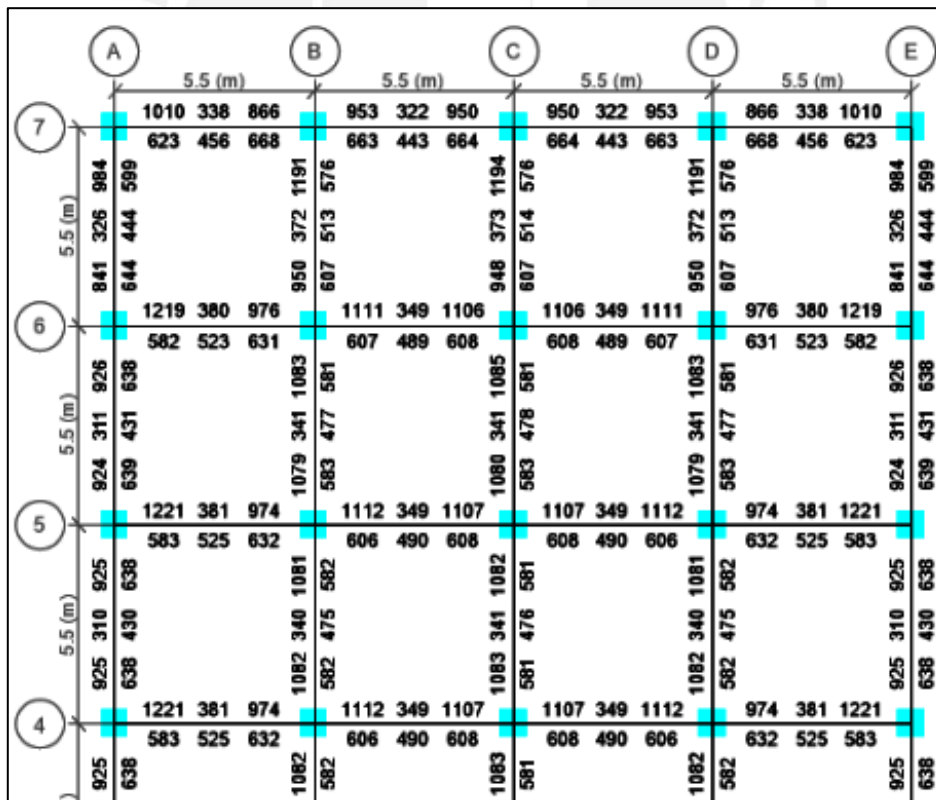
Aceros de refuerzo grado 75 (mm²) en vigas del nivel 3 (planta)
